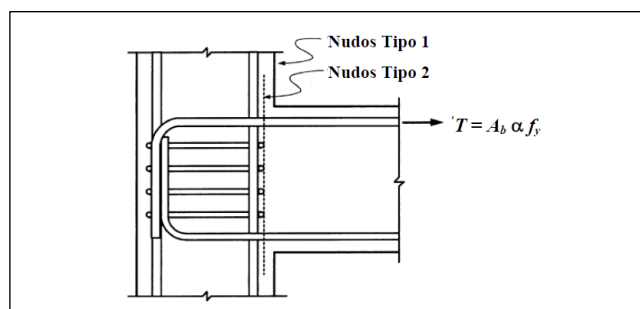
Sección crítica para el desarrollo del refuerzo longitudinal de viga que termina en nudo. Fuente: ACI 352 R-02, p. 21.
